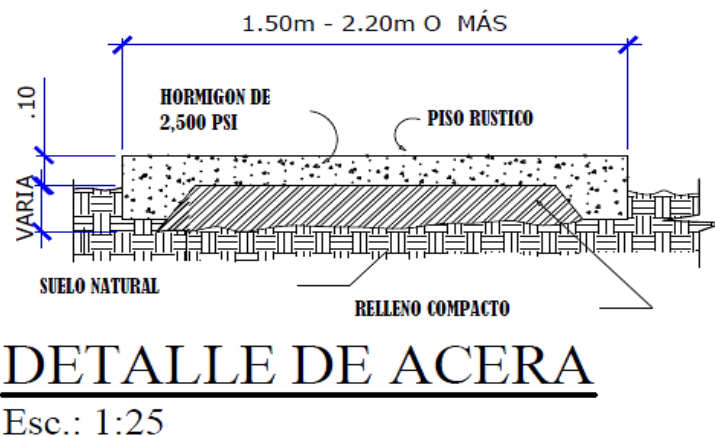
Detalle de acera. Fuente: Planos del proyecto, 2023.
